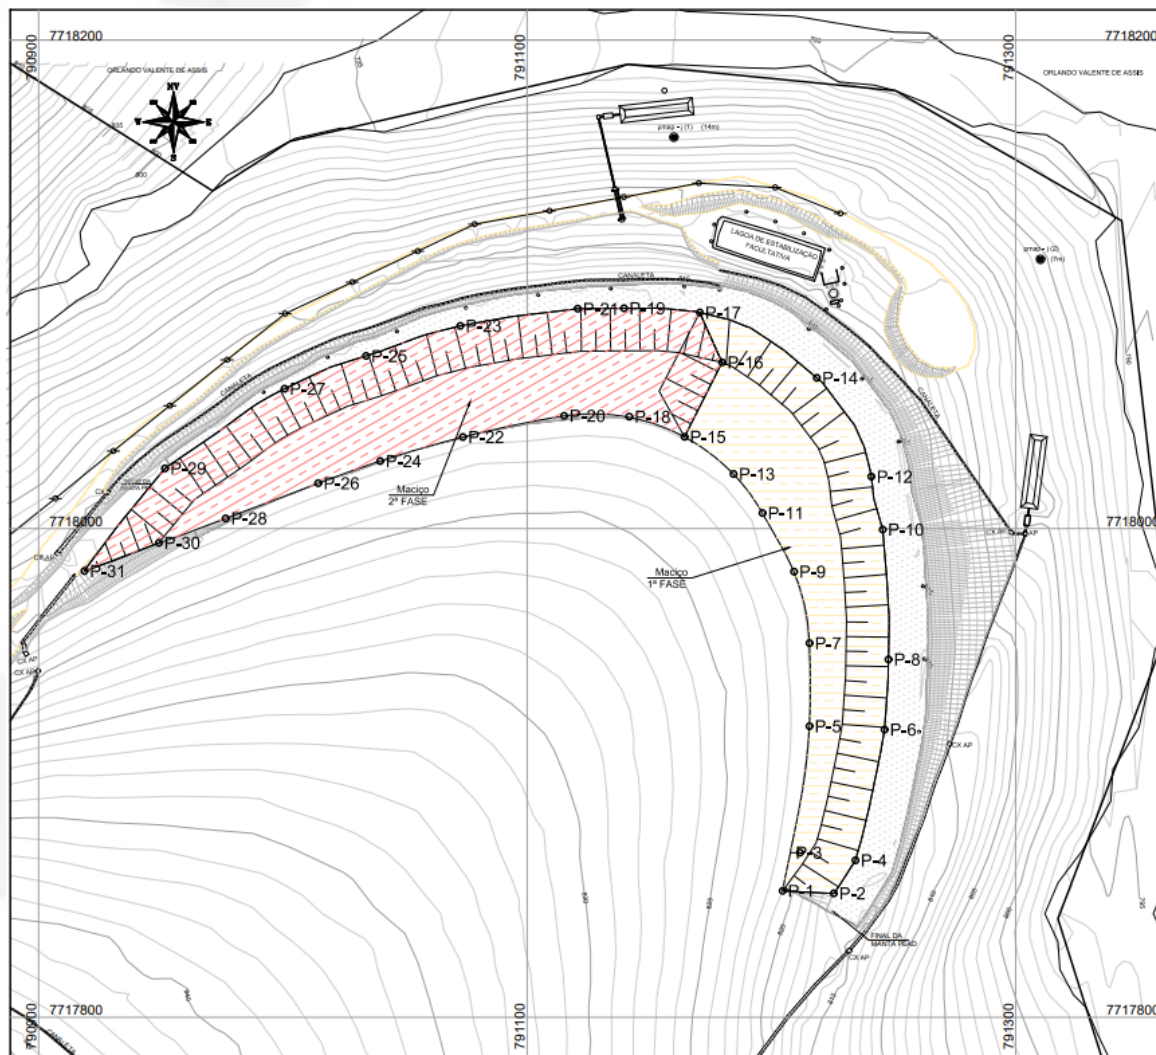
Planta da plataforma 1: aterro maciço 1ª fase e 2ª fase.
